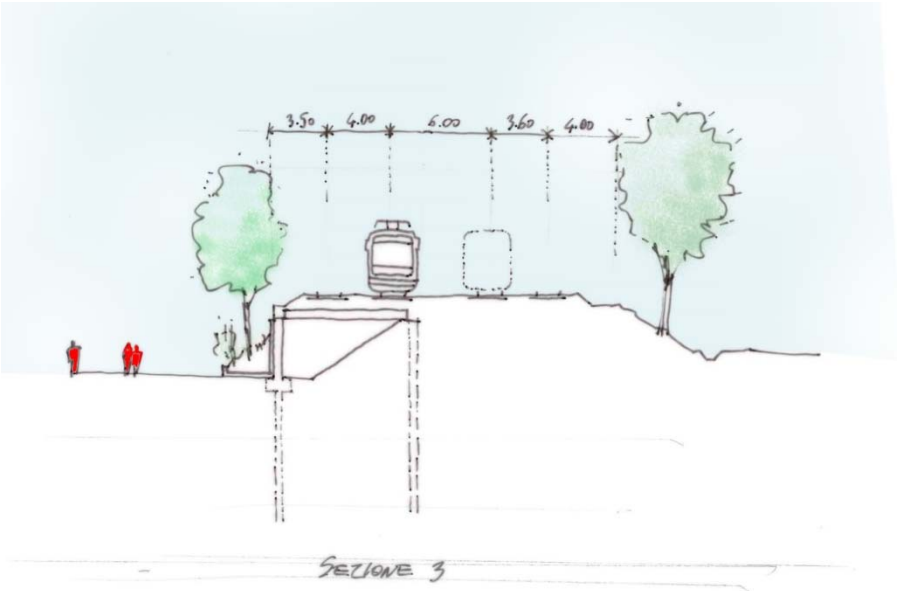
Tipologia di intervento a basso impatto geotecnico sul rilevato esistente
